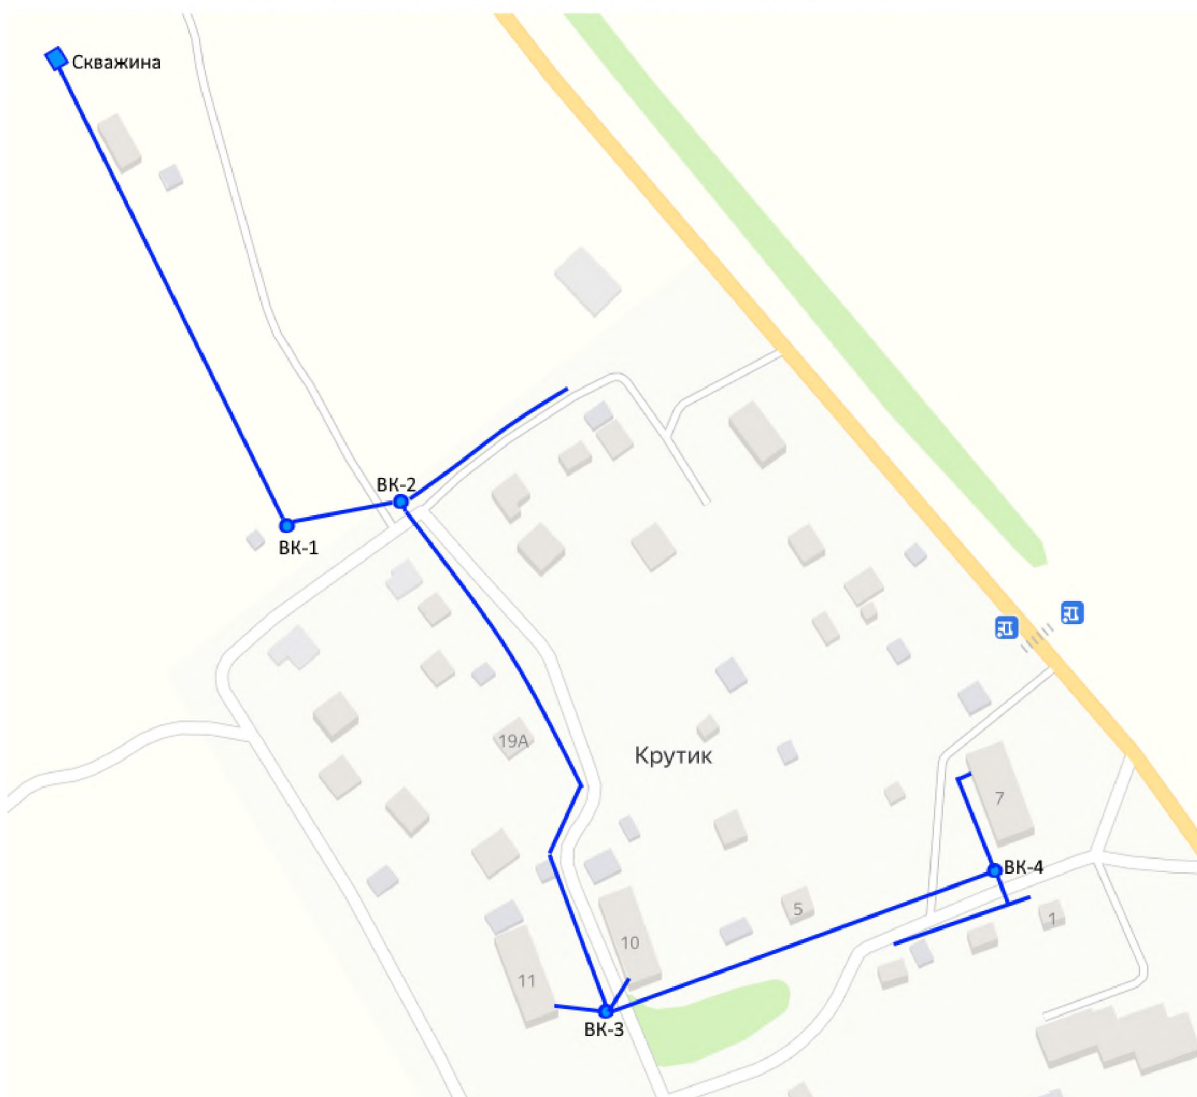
Схема водопроводных сетей п. Крутик
